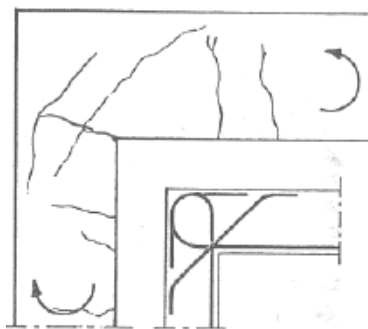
Fisuras y Disposición de Armado para Momentos Positivos\
